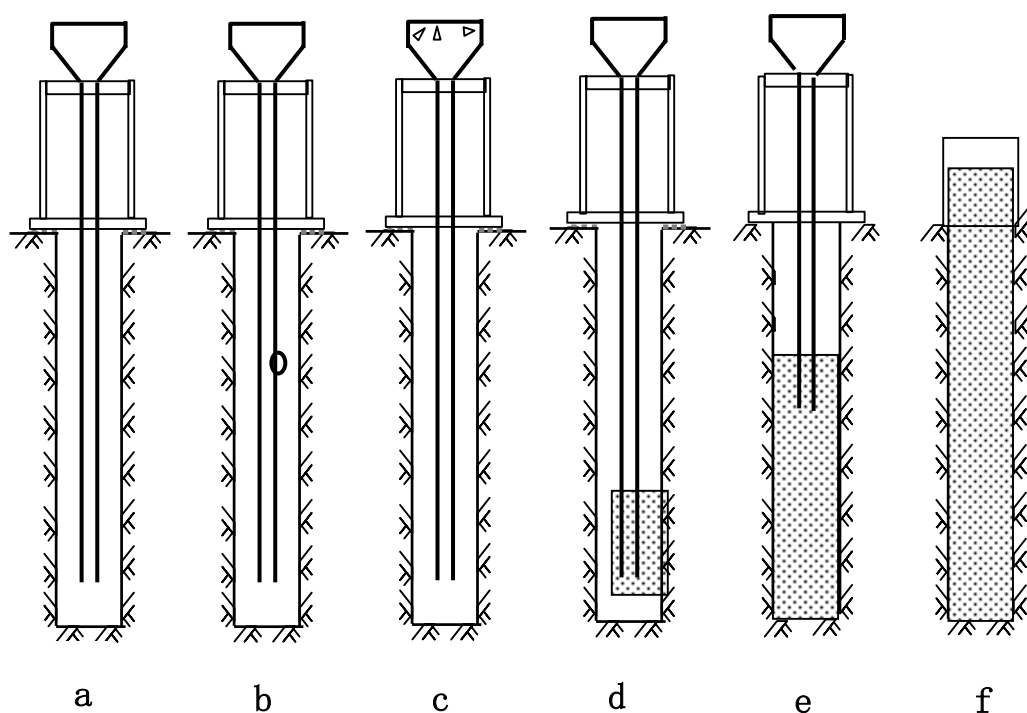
钻孔灌注桩水下混凝土灌注过程示意图
